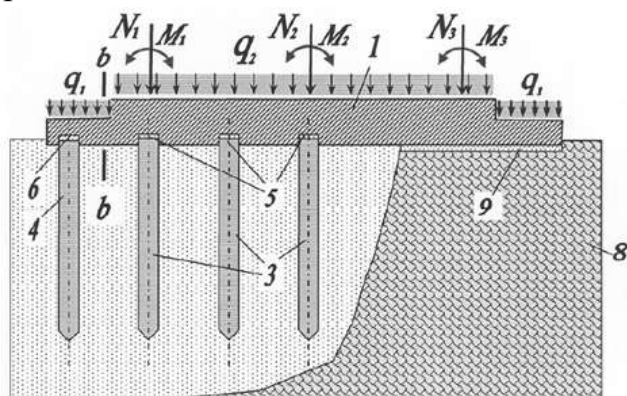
Свайно-плитный фундамент, где 1 – монолитная сплошная плита; 2 – ростверк; 3 – центральные сваи; 4 – крайние сваи; 5 – демпфирующие прокладки над оголовками средних свай; 6 - демпфирующие прокладки над оголовками крайних свай; 8 – толщина прочного (скального) грунта; 9 – демпфирующая прокладка, компенсирующая неравномерность осадков, под монолитной плитой [70].
